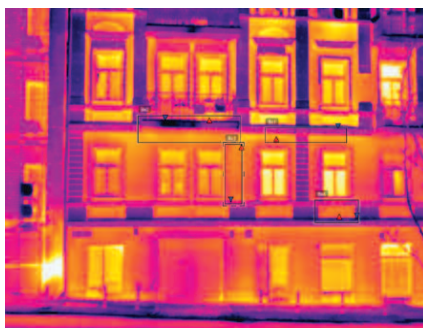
Zdjęcie termowizyjne elewacji zachodniej budynku przy ul. Zana 16
